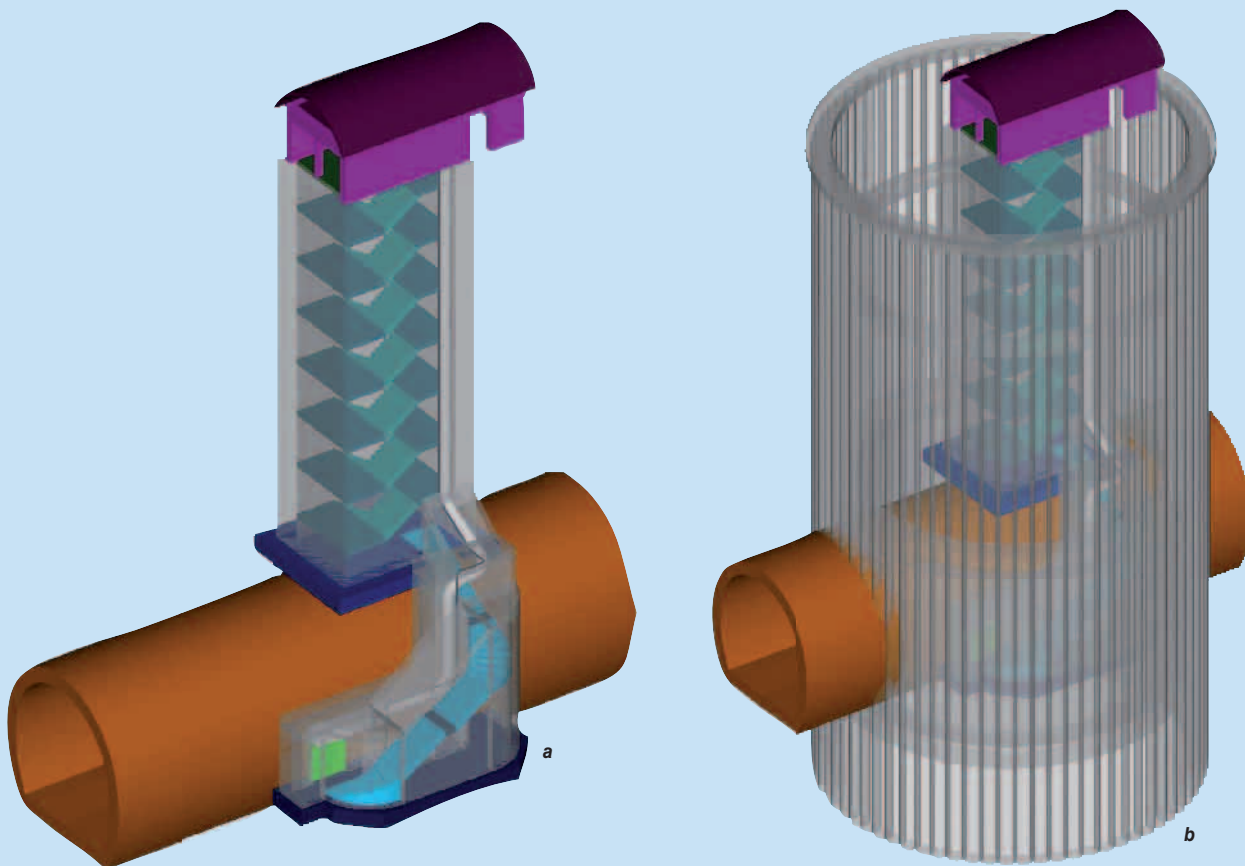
Podélný řez nerealizovaného návrhu zmáhání závalu pomocí dvou šachet průměru 18,0m
